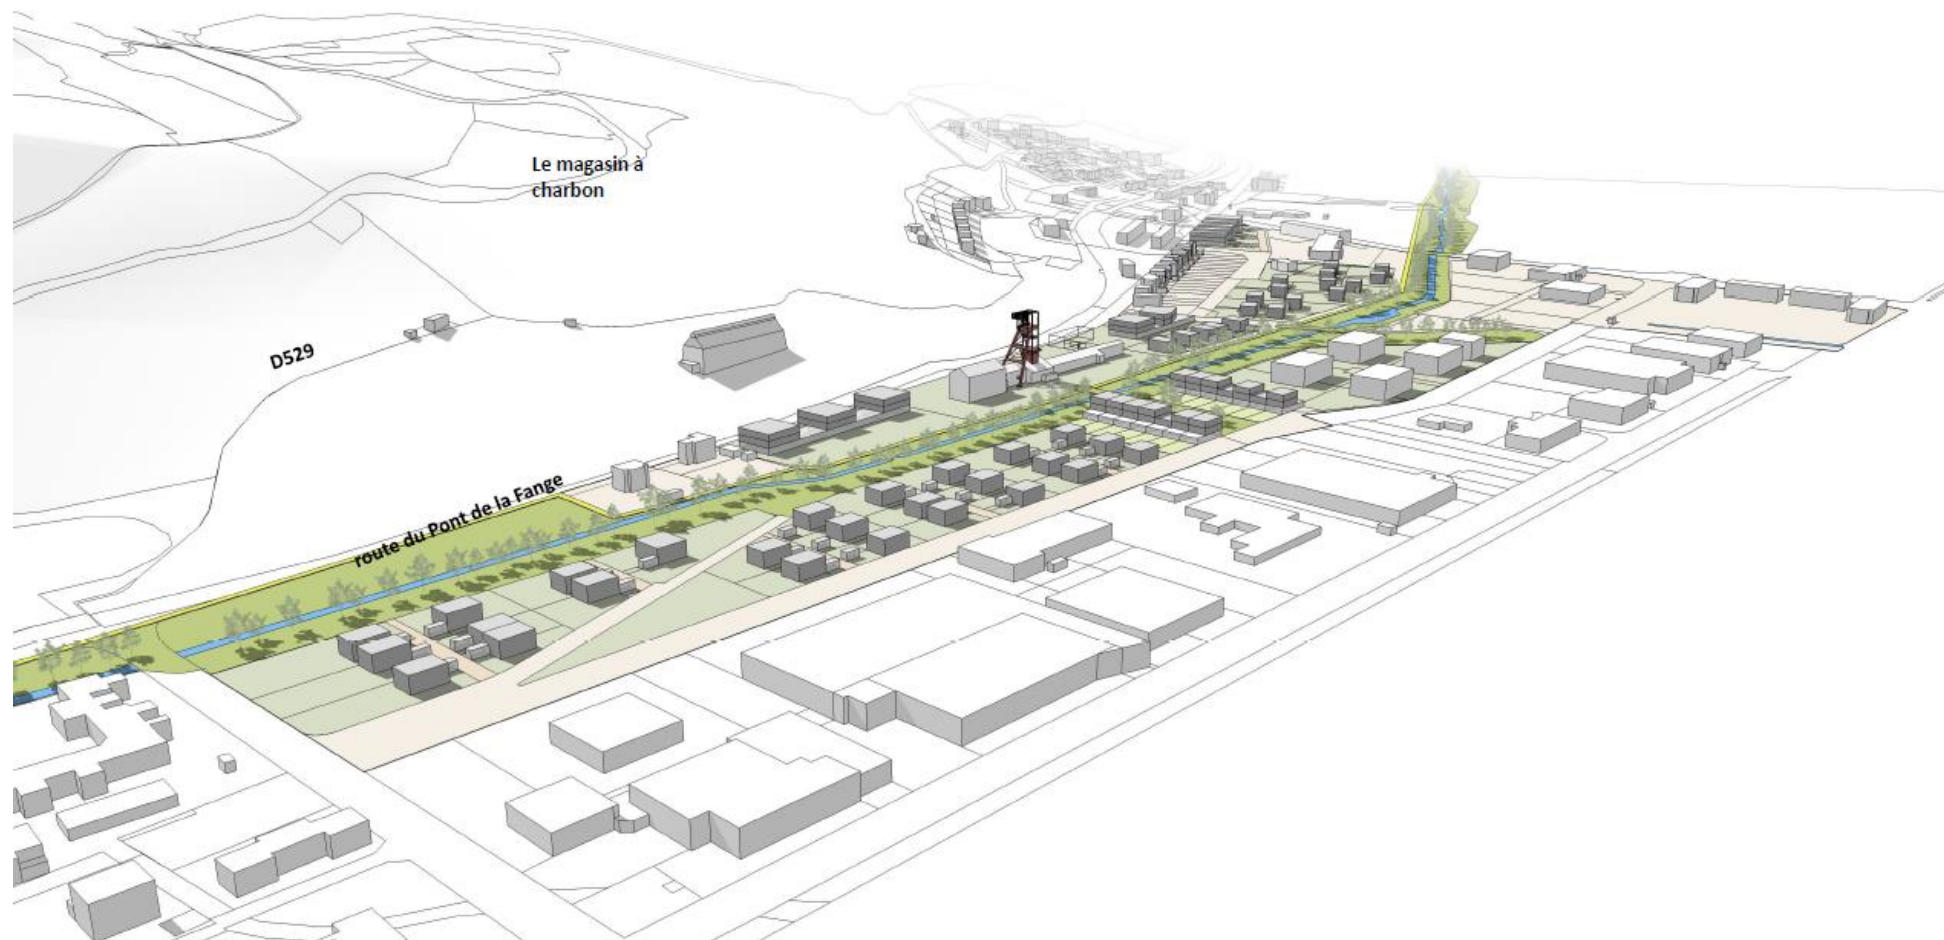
Plan 3D simplifié illustrant la topographie du site et le plan masse du projet urbain (source : Architecte Benoit ADELIN, ELEGIA)
